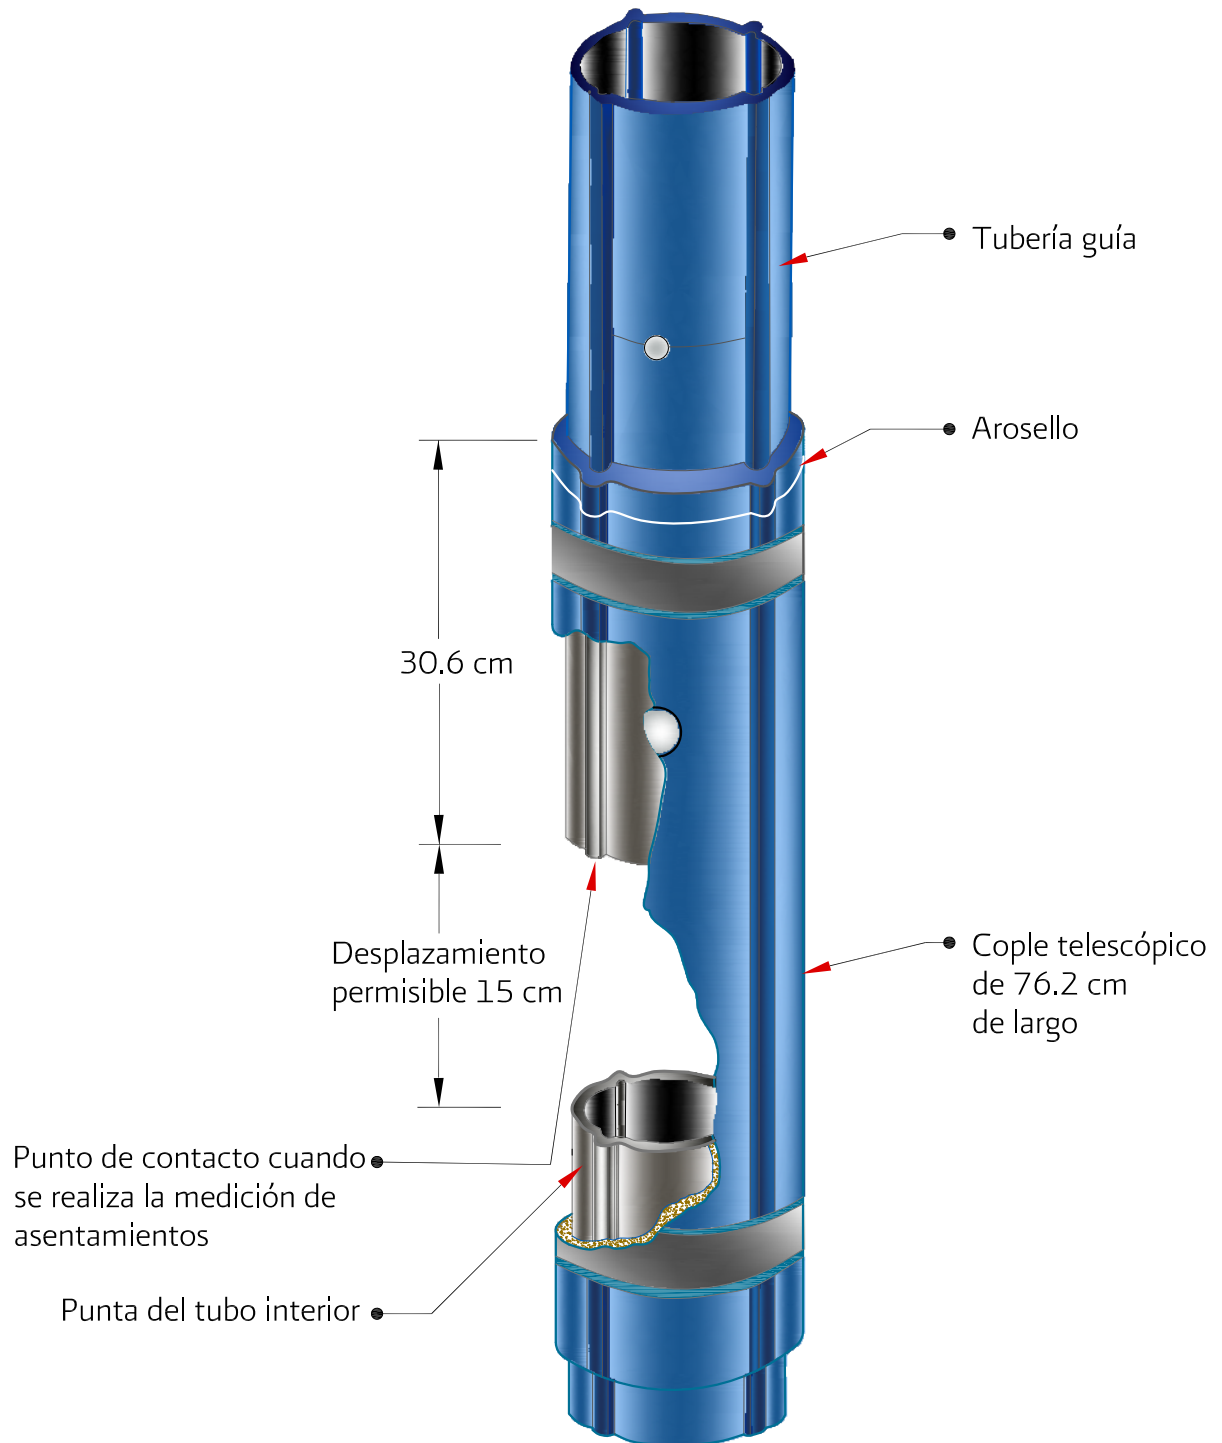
Detalle de acoplamiento telescópico y tubo guía del inclinómetro
